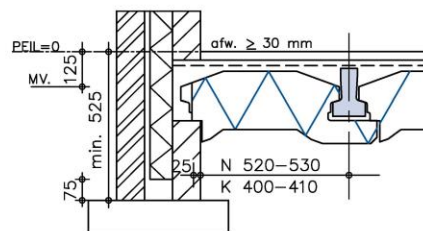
DETAIL - EINDOPLEGGING ZONDER RANDKIST
